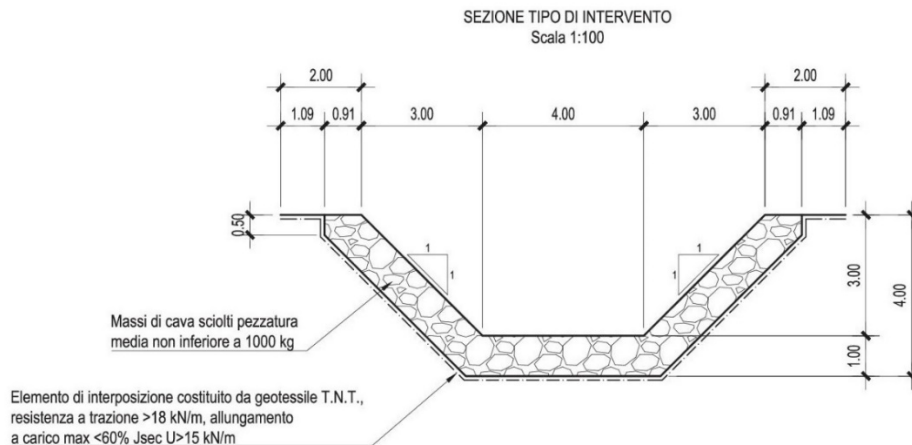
Sezione tipo di intervento sul Rio dei Deglia
